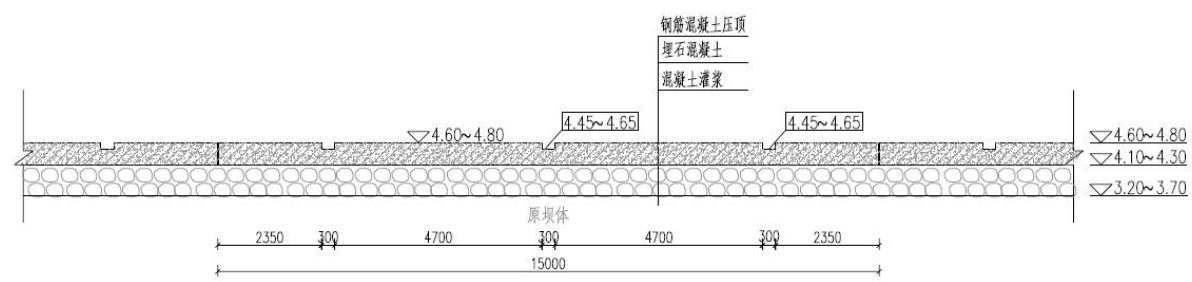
原有驳岸维修断面坝顶 15m 标准段剖面图
